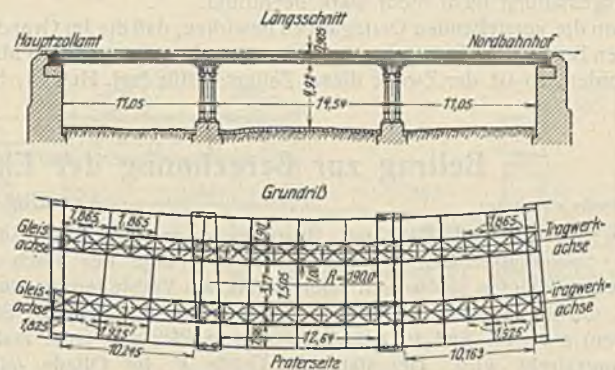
Schematische Darstellung der Brücke über die Lassallestraße in Wien der Wiener Verbindungsbahn (Nordbahnhof—Hauptzollamt).
